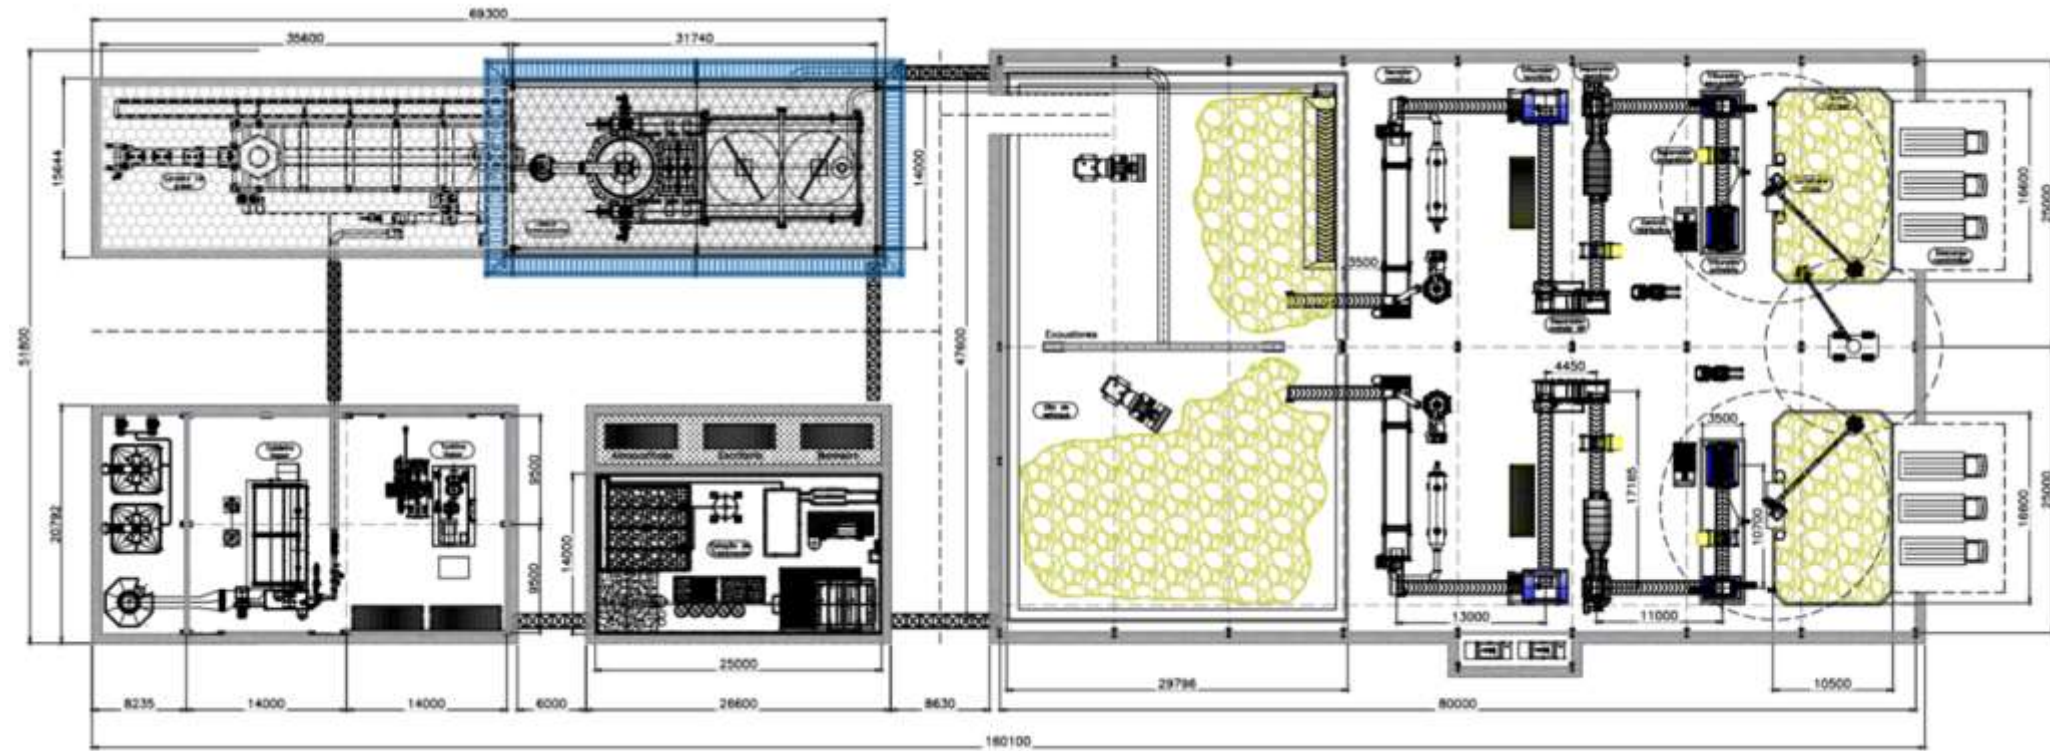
Planta Geral - Exemplo de layout para planta de 300 ton/dia de RSU - 10.000 m<sup>2</sup>
